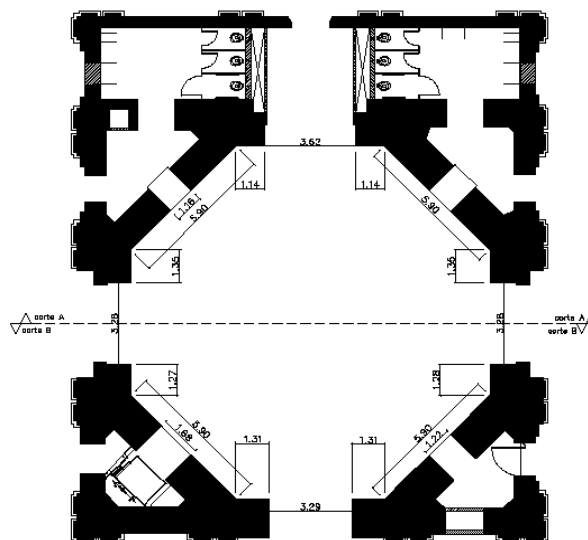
Planta do espaço expositivo Octógono da Pinacoteca
